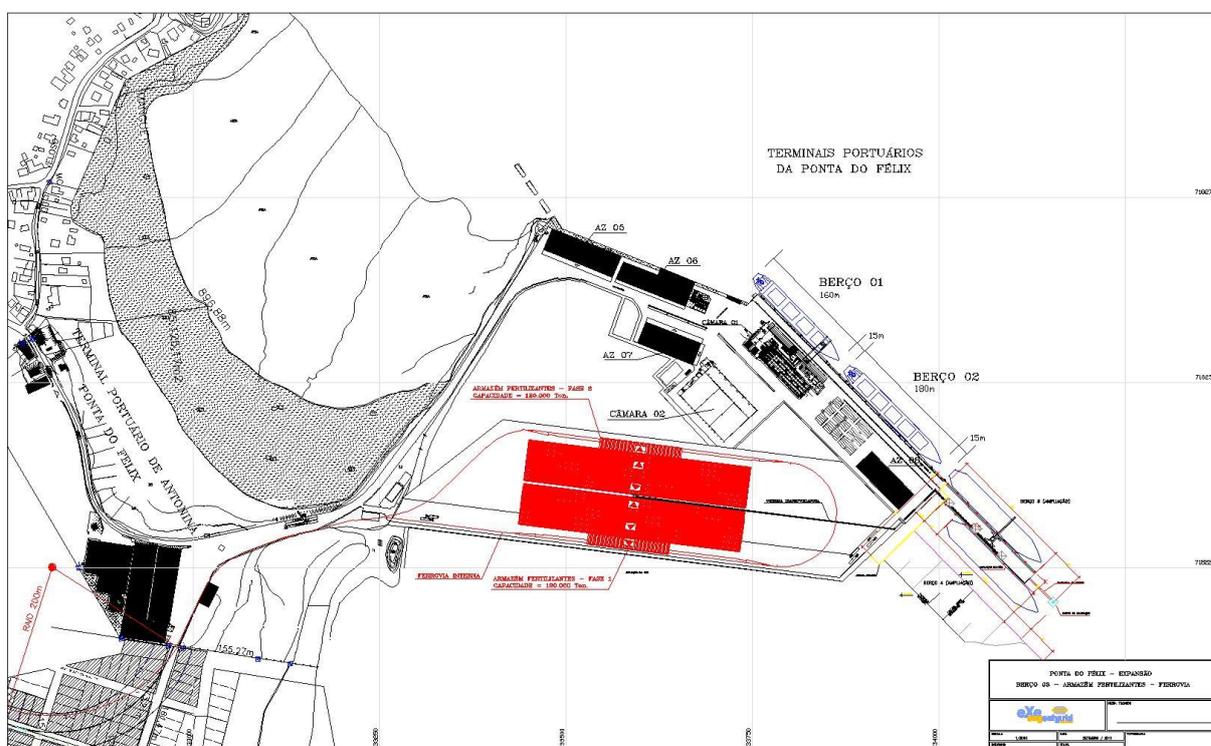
Layout Futuro do Terminal da Ponta do Félix
